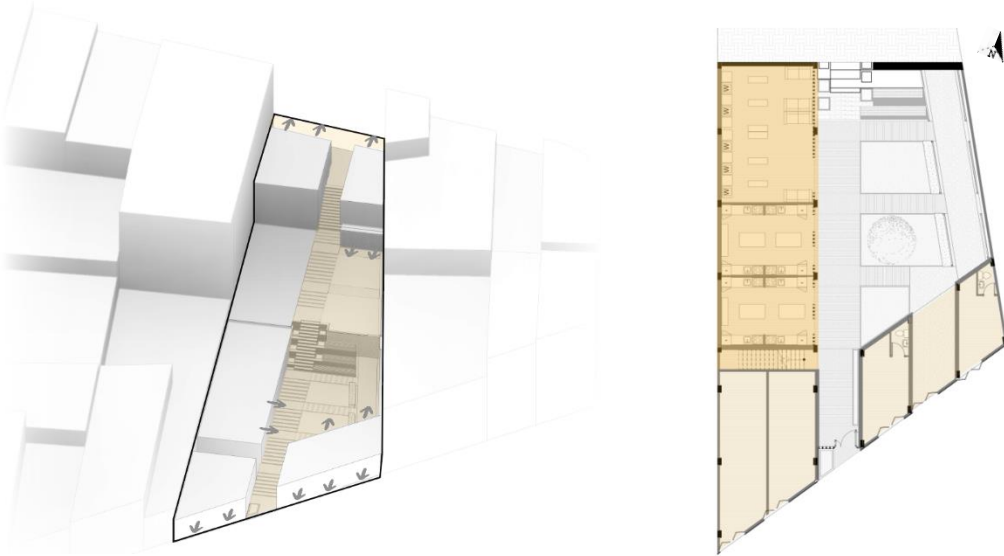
Planta libre(izquierda), área de lavandería (derecha)
